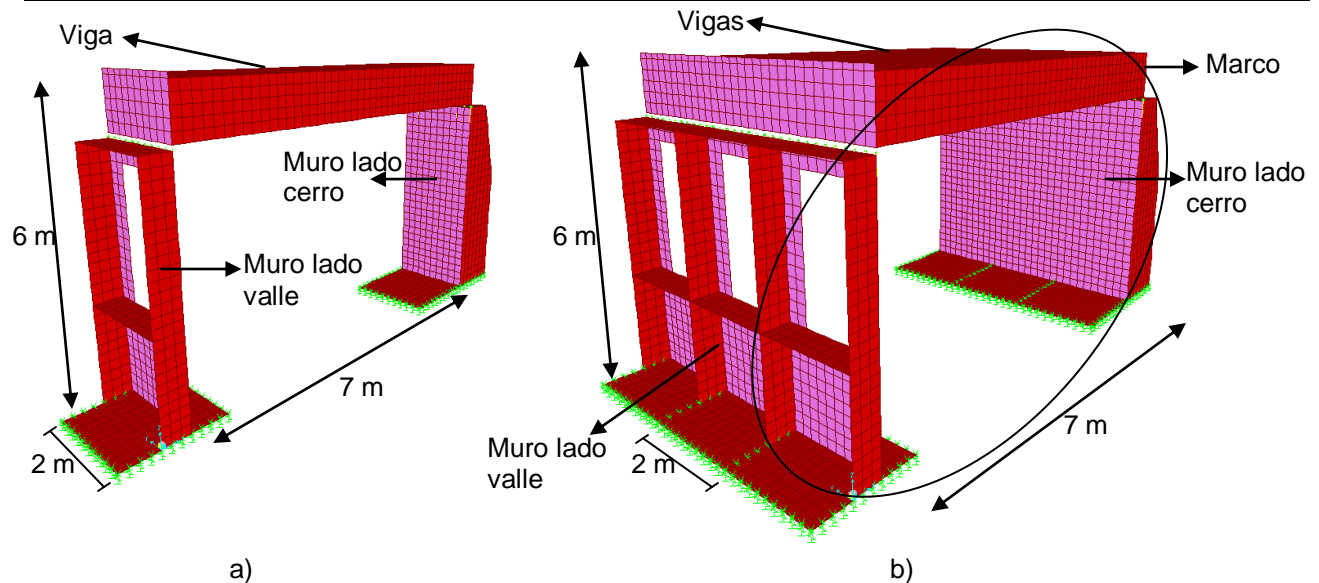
Estructuración de los cobertizos. a) estructuración de un marco b) conjunto de marcos.
